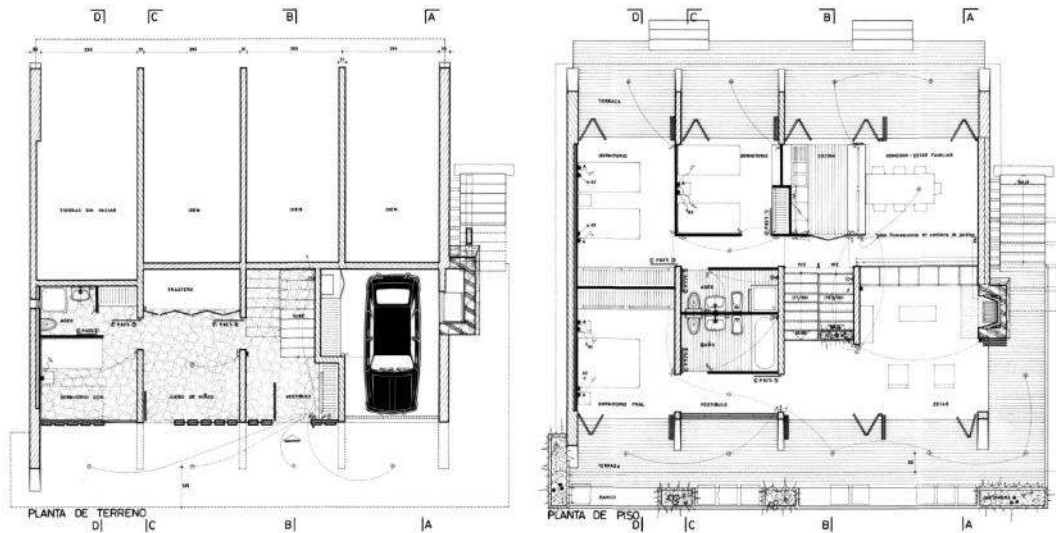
y 14. Casa Vázquez. Planta baja y primera. Plano 3. Redibujado en 1982. (Archivo X.B.B.: Proyecto nº 57).
